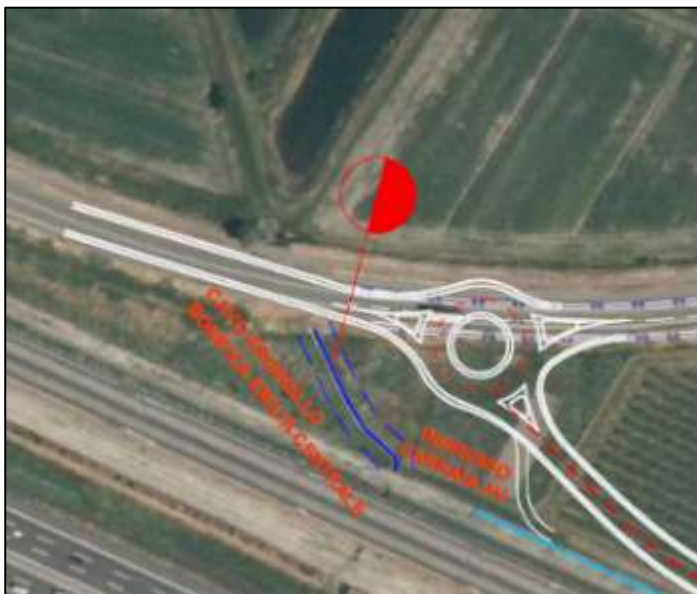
Estratto Tav. 3 PLANIMETRIA DI PROGETTO SU ORTOFOTOPIANO.
